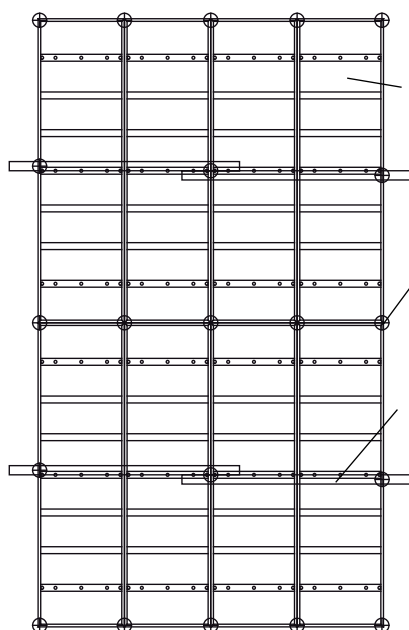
Dos vigas H20 para encofrado, c/u soportando un campo
